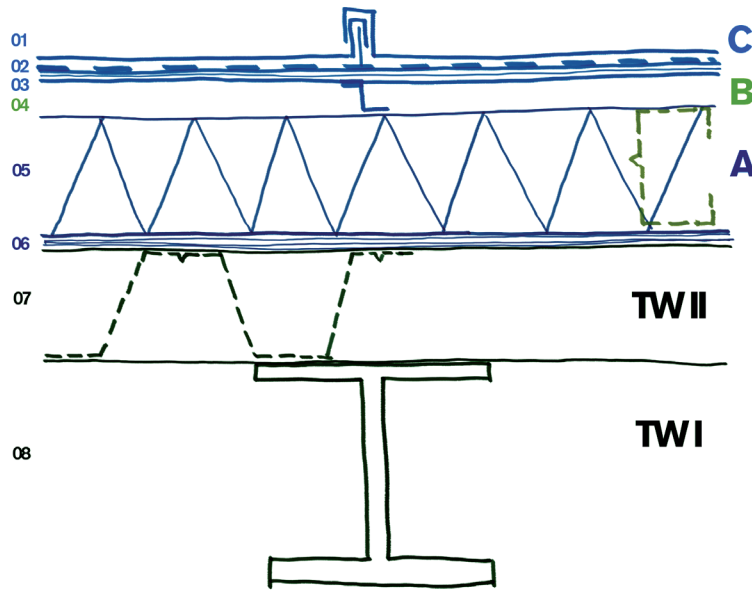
Skizzenhafte Darstellung des Dachaufbaus, Fallstudie B (Stahlbau)
